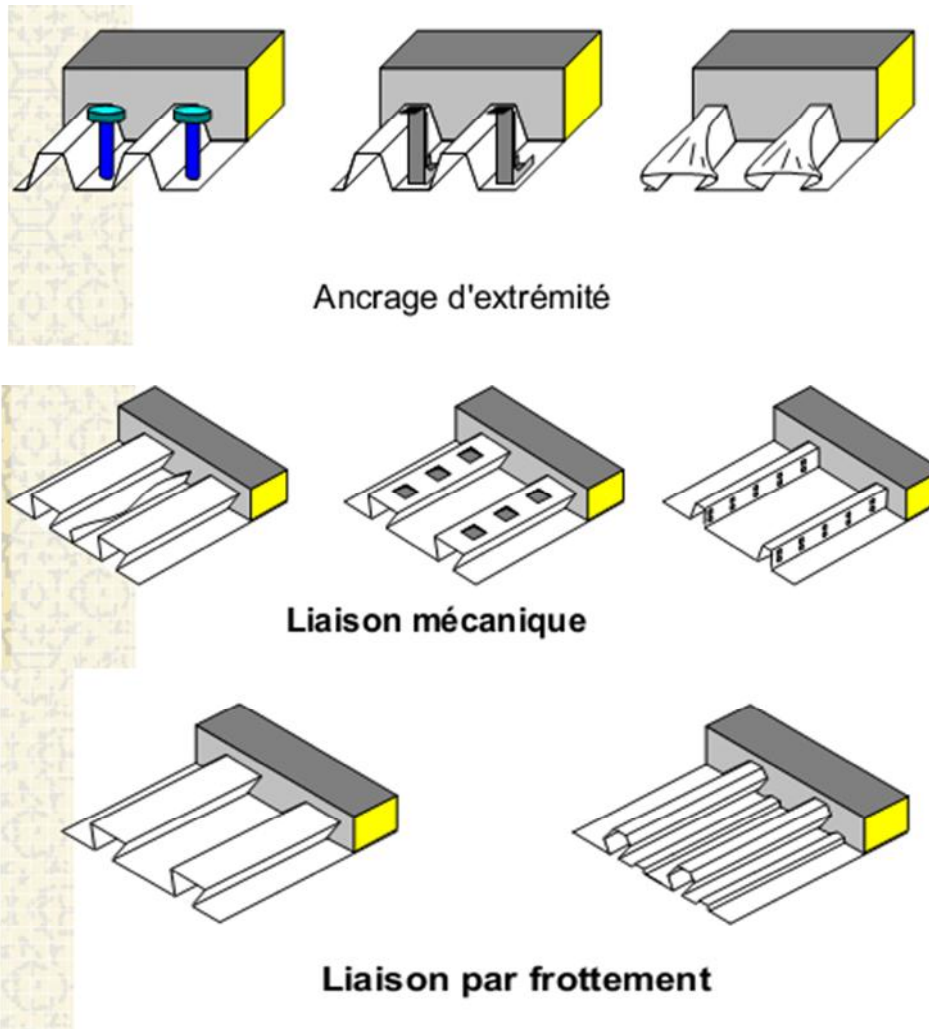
Dalles mixtes avec tôles profilées collaborantes.
